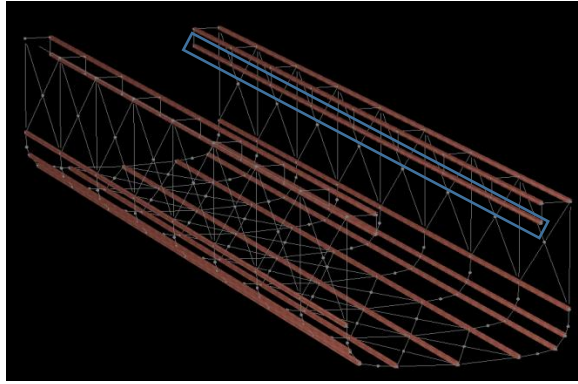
Reforzamientos longitudinales soldado.
